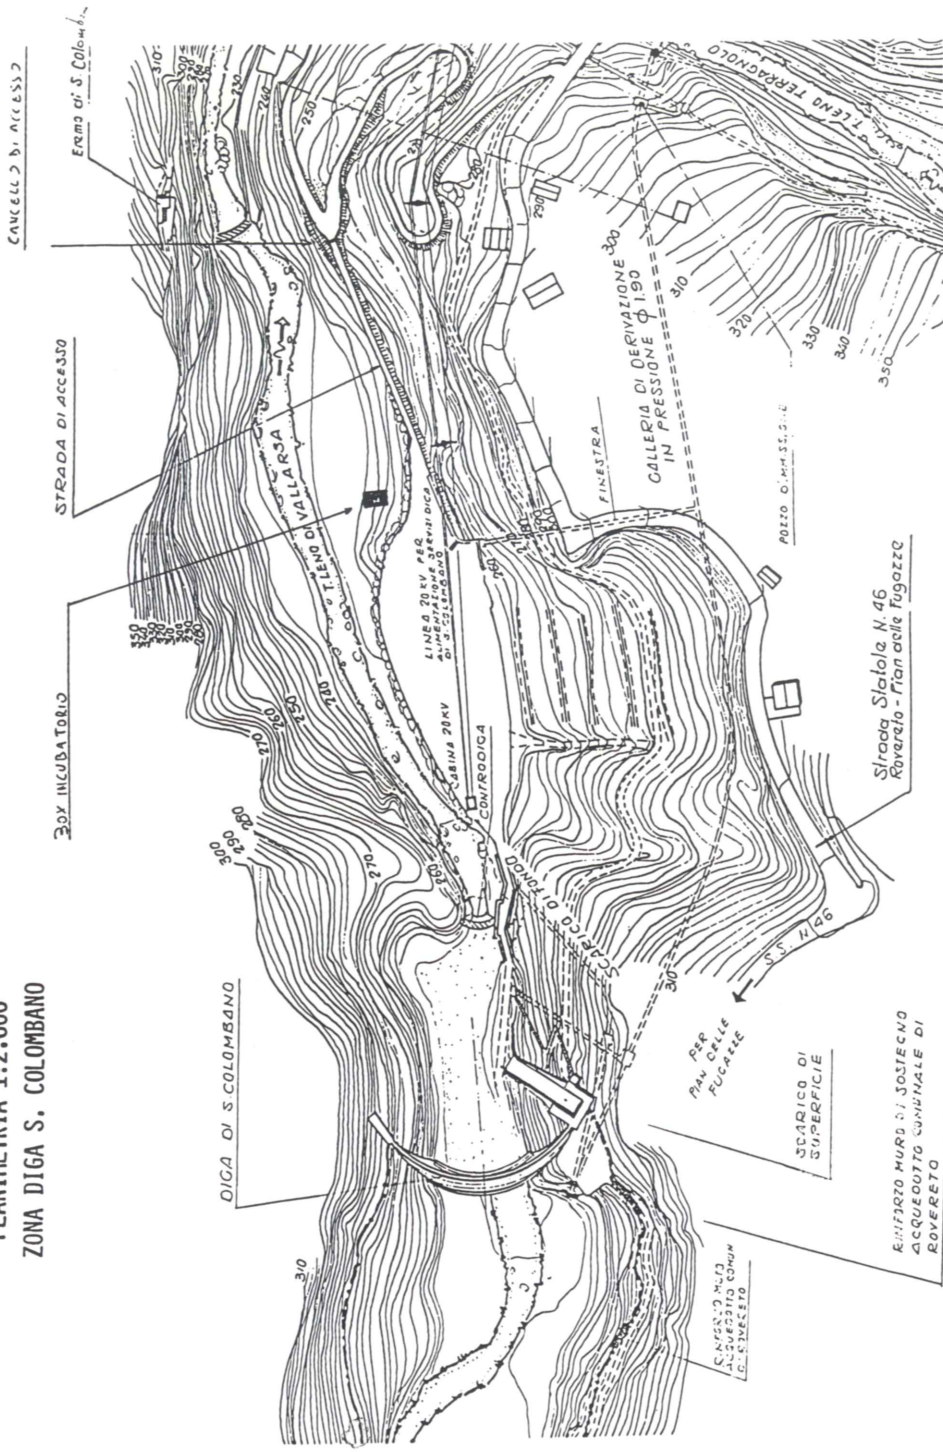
Planimetria 1:2.000 - zona diga S. Colombano.
